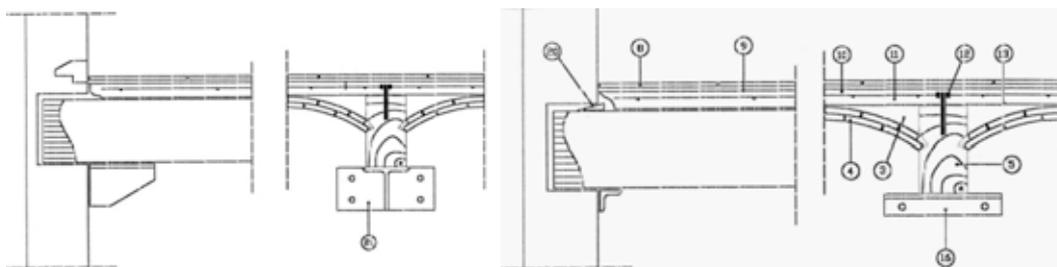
Refuerzos en las vigas de madera de los forjados, con piezas metálicas para el refuerzo en los apoyos.
